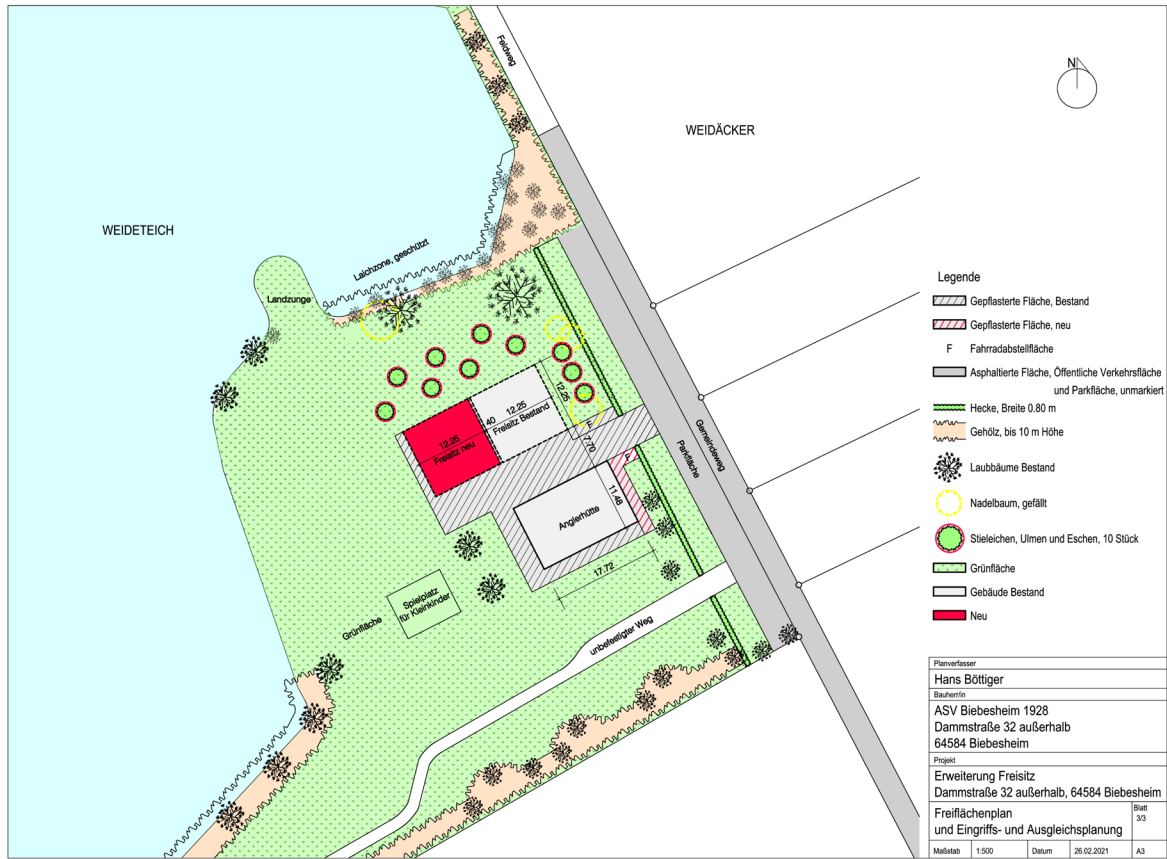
Freiflächenplan, Quelle: Architekt Hans Böttiger
